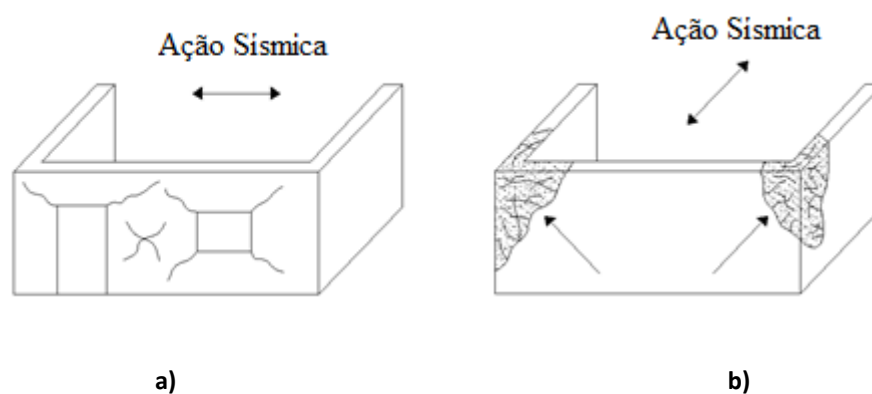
Fissuração: a) No plano da parede b) Fragilização dos cunhais (Costa - 2013)
